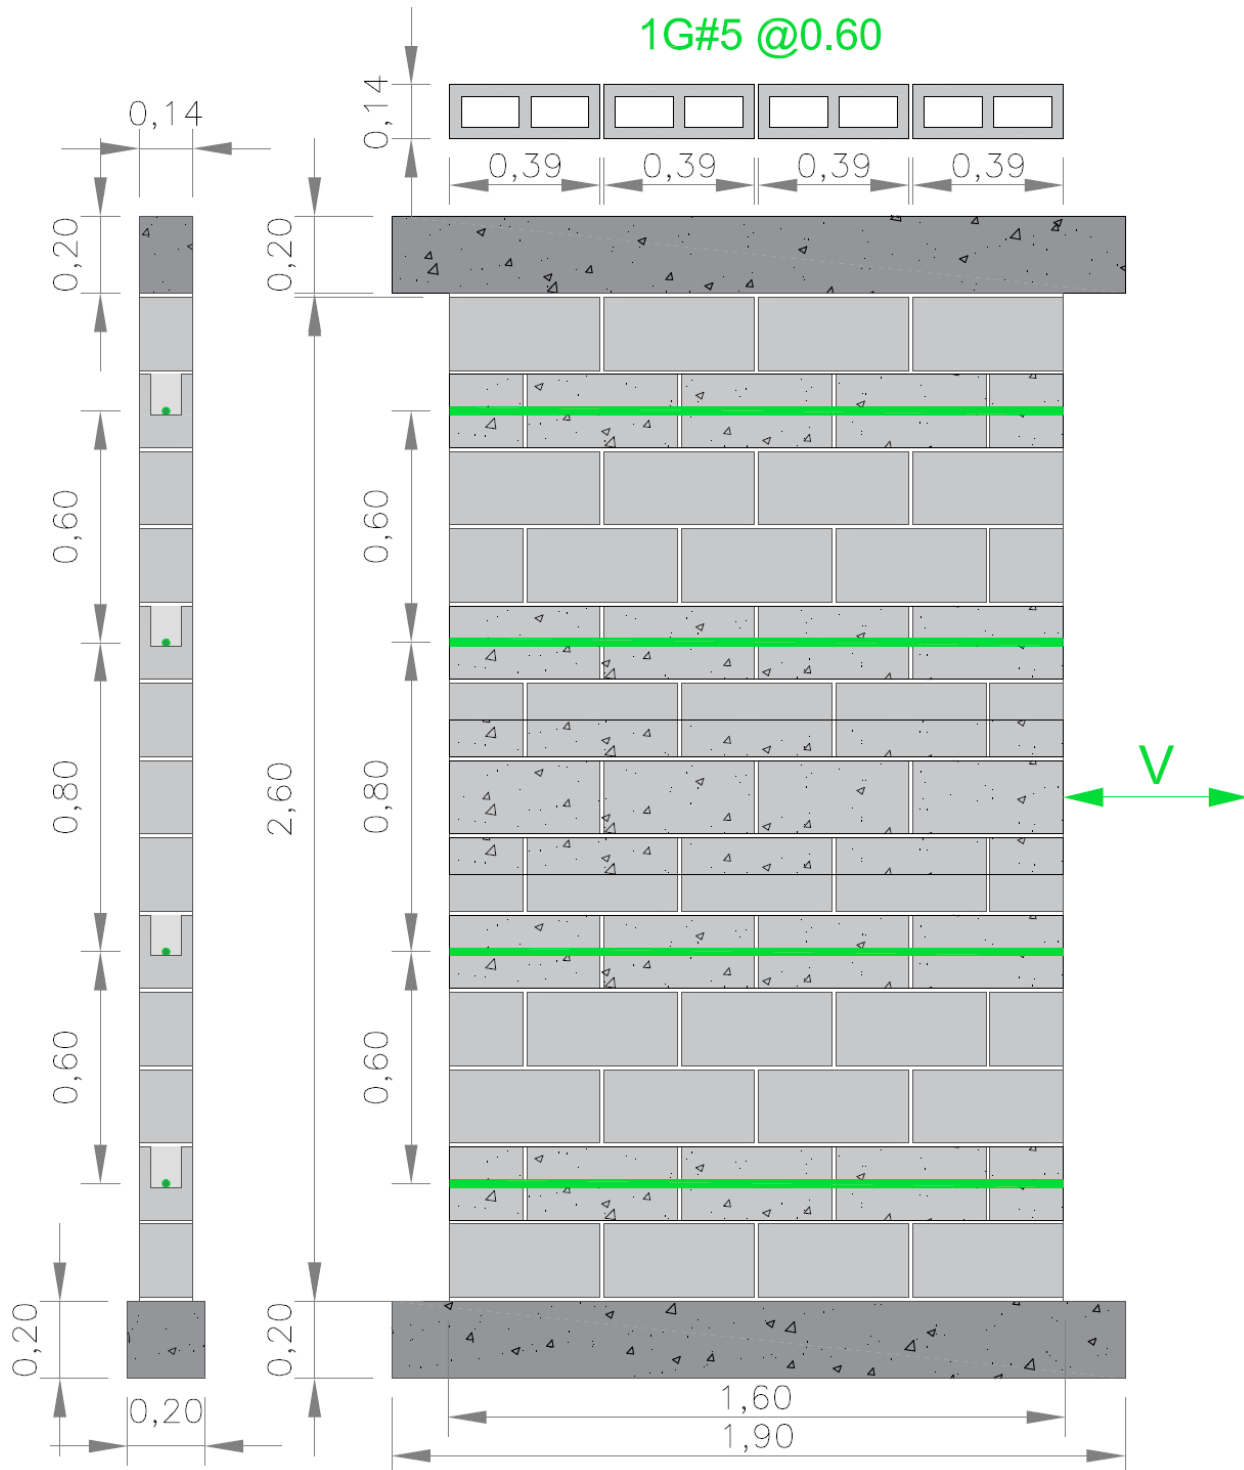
Configuración del refuerzo del muro MC-1#5/60
